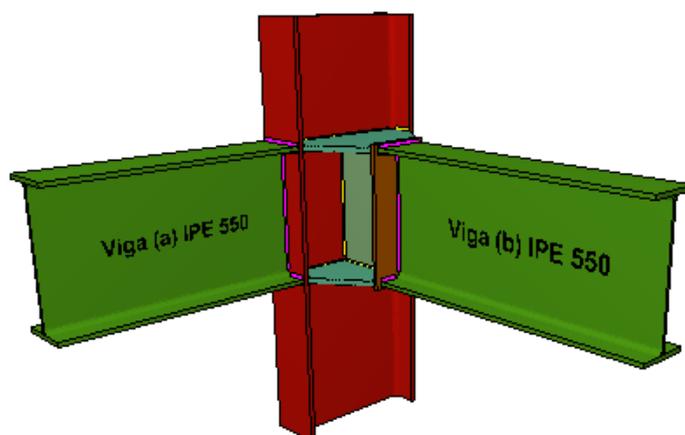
Soldadura S1. Fuente: CYPE 2017
